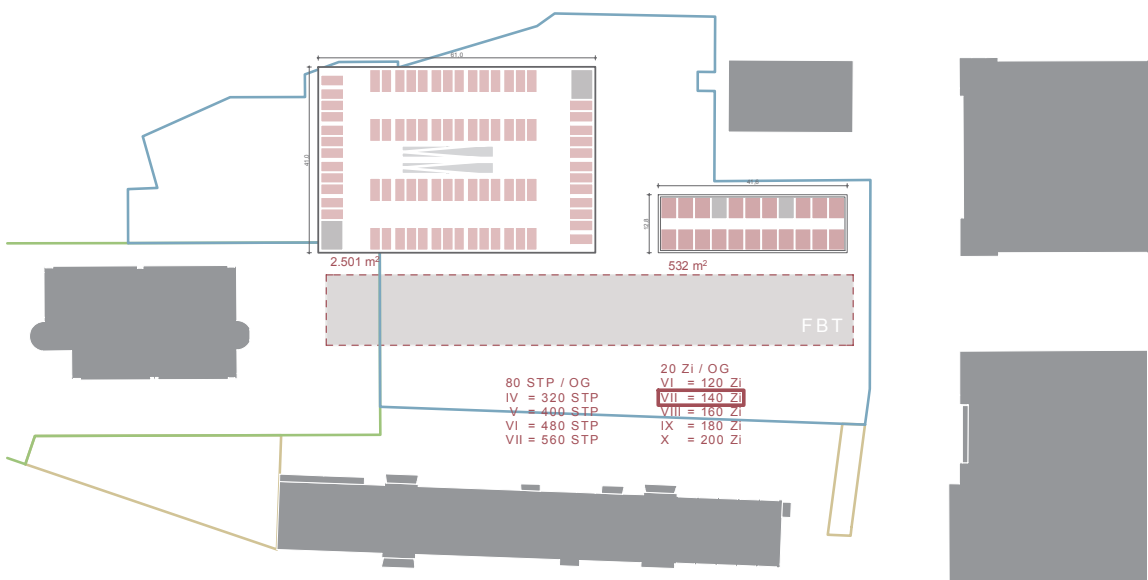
Standort AB - Variante B – Systemgrundriss Regelgeschoss
